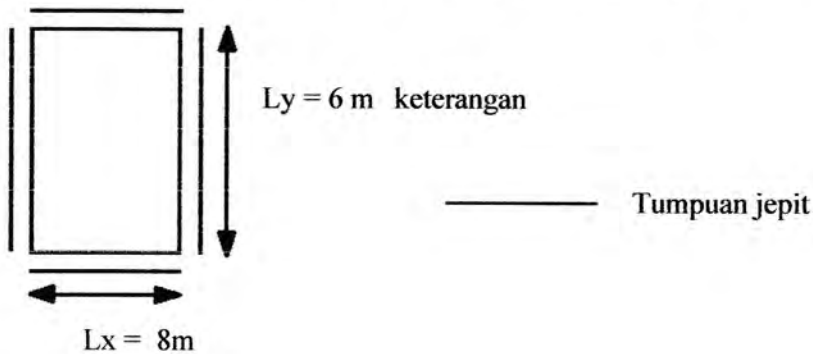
Bagian Plat Lantai yang di tinjau
